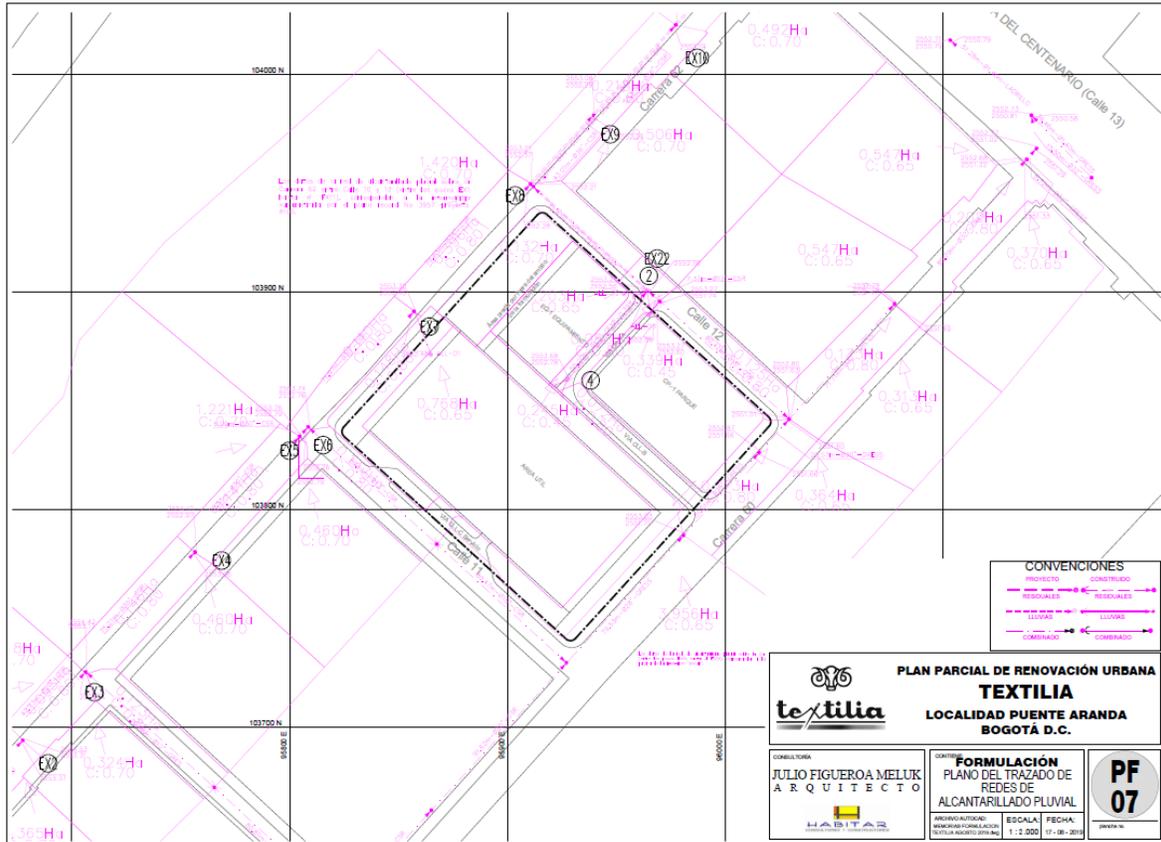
Plano PF-07 Trazado de Redes de Alcantarillado Pluvial
